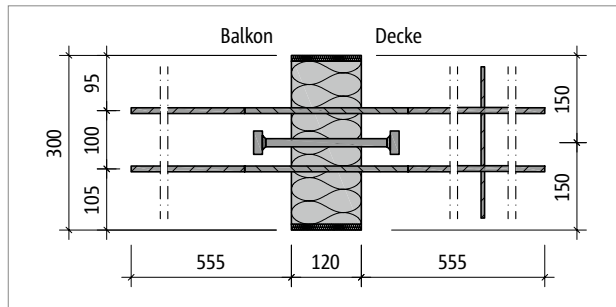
Schöck Isokorb® XT Typ QP-V1: Produktgrundriss
